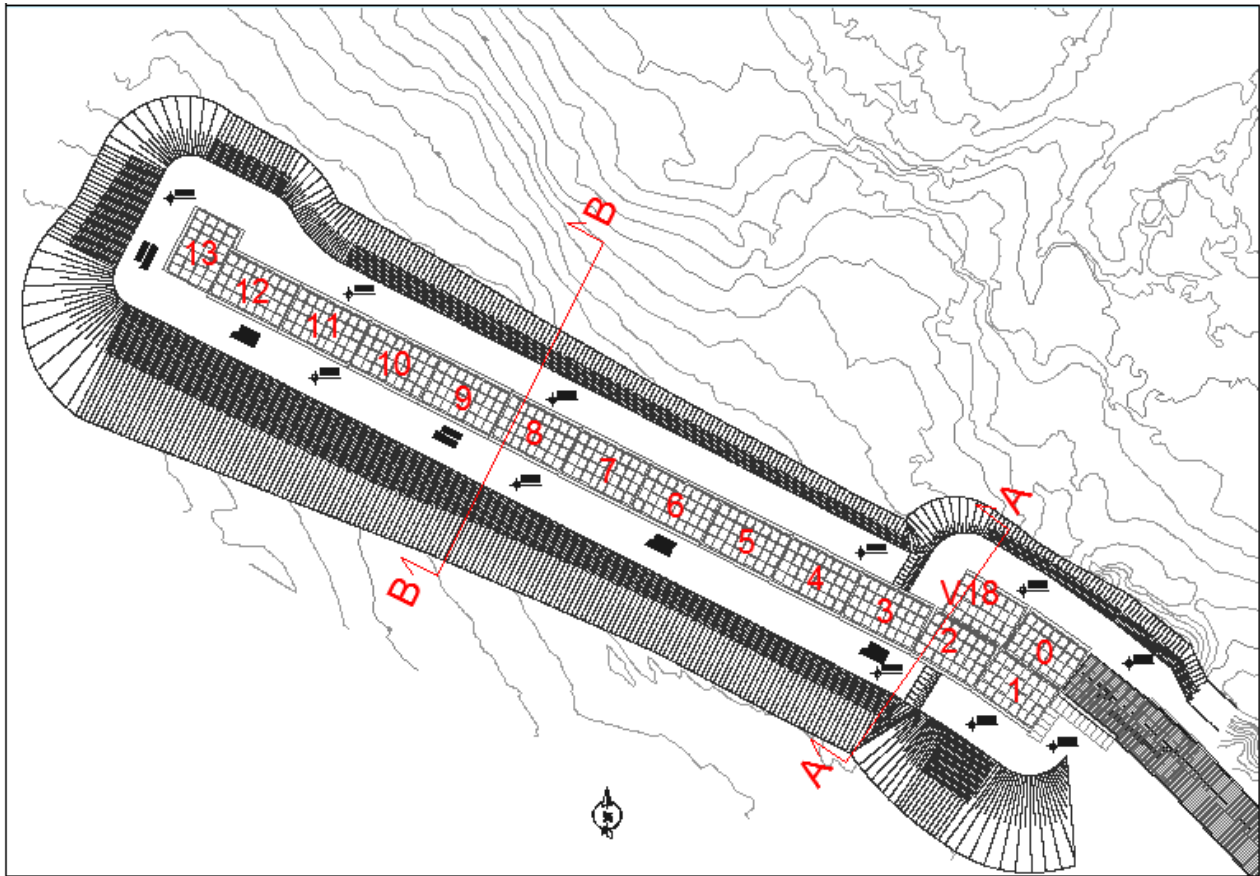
Planimetria posizionamento cassoni con individuazione delle sezioni tipo
